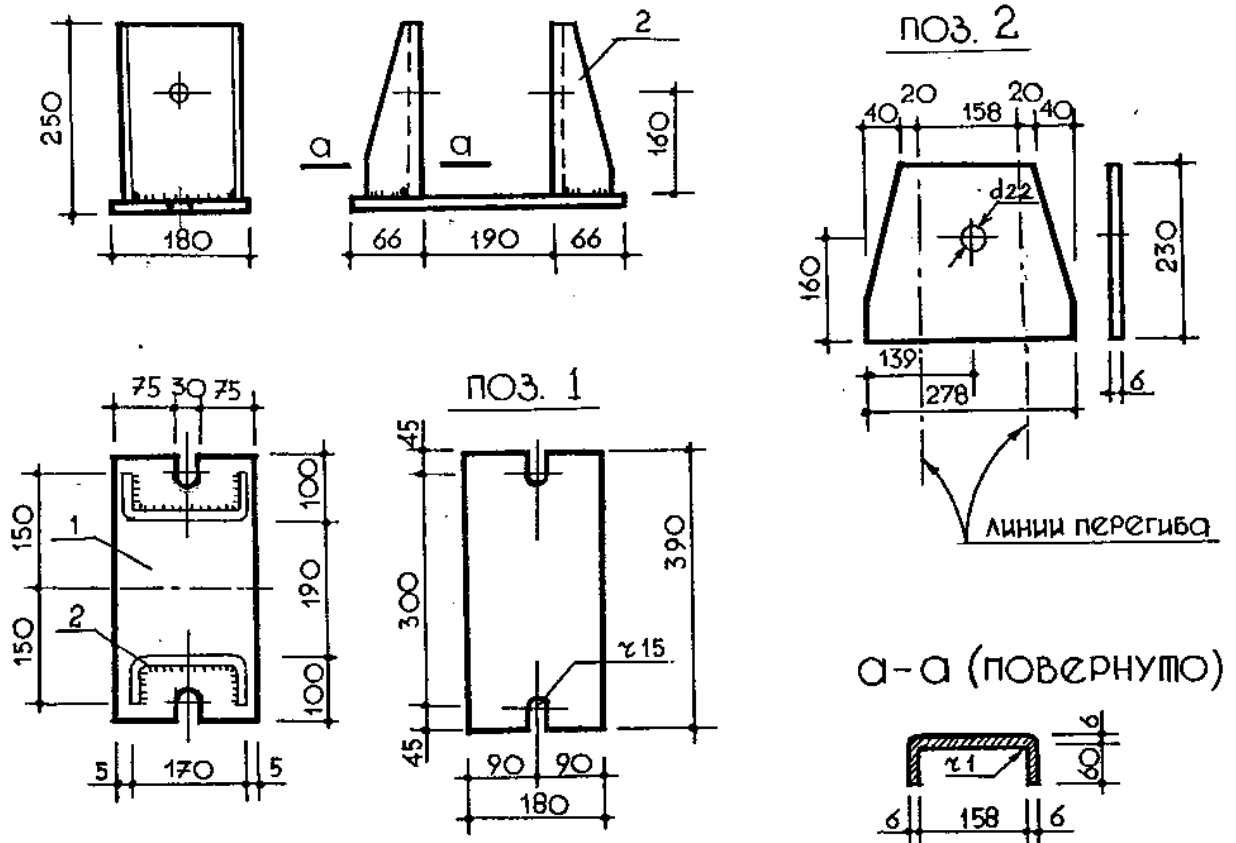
Конструкция опорного башмака при опирании балки на колонну, обвязочную балку или пилястру
